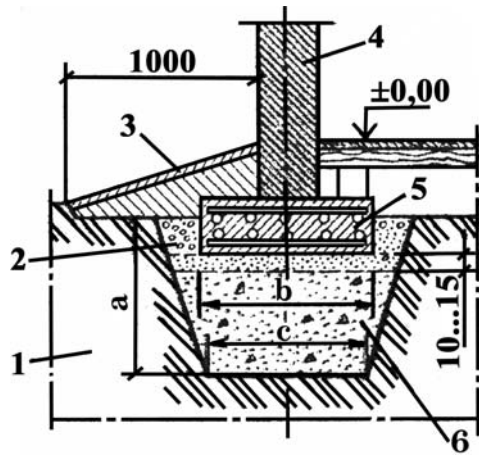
Конструкция незаглубленного фундамента: 1 — материковый грунт; 2 — засыпной грунт (гравий, щебень, песок); 3 — отмостка; 4 — стена дома; 5 — основание — железобетонная постелистая плита; 6 — утрамбованный грунт с песчаной подушкой толщиной 10–15 см; а, б, с — размеры по месту.
